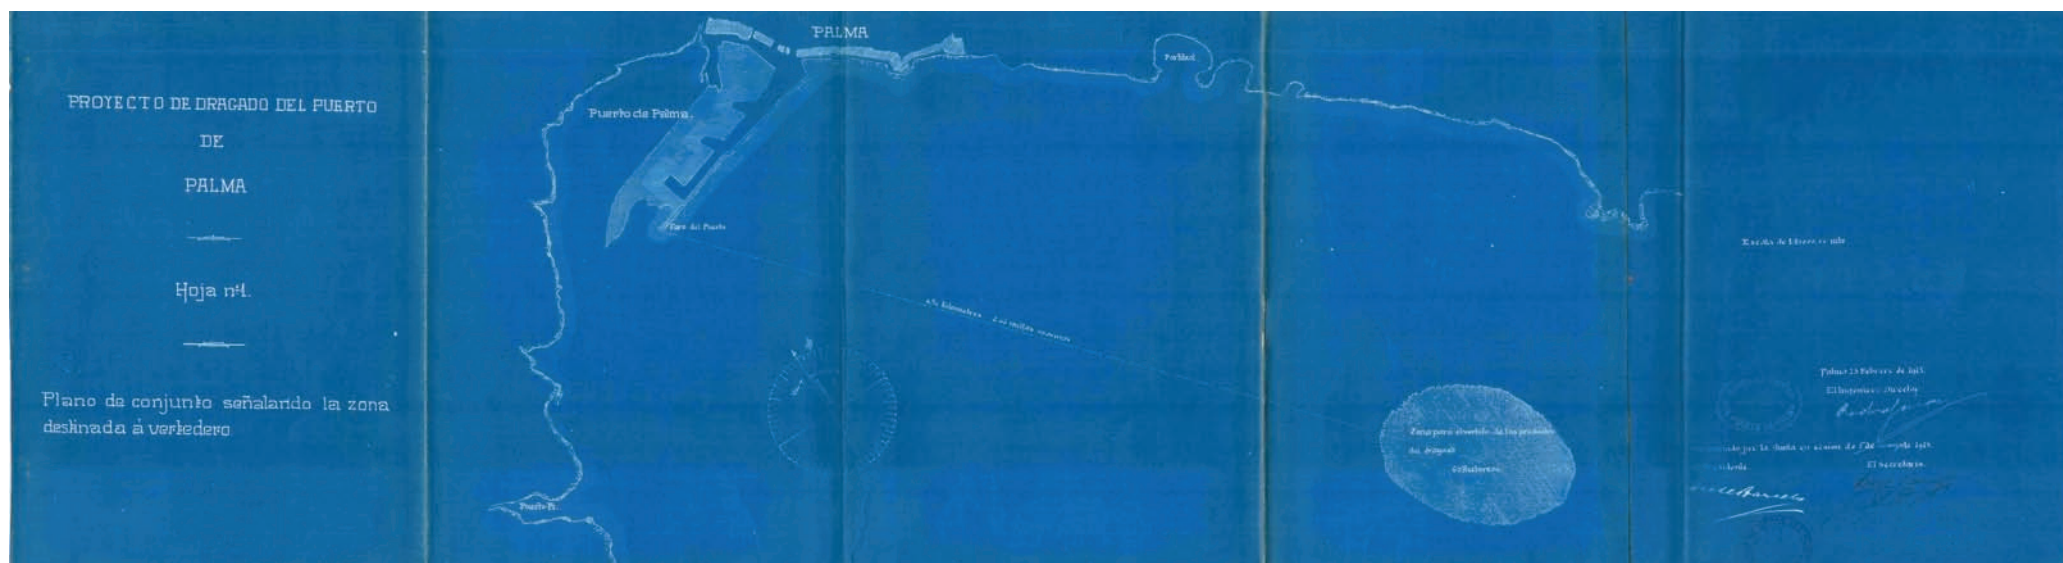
Planta de conjunto del proyecto de *Dragado del puerto de Palma*, redactado por Pedro Garau en 1915.
